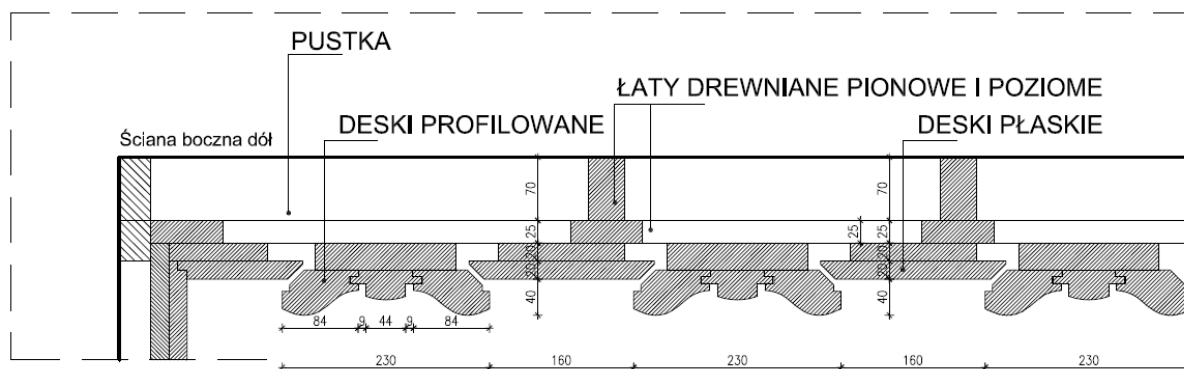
Schemat budowy estrady z materiałów archiwalnych.
